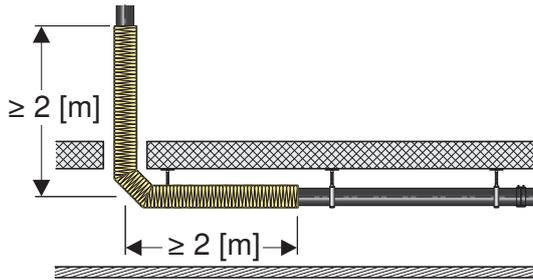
Luftschalldämmung im Bereich eines Falleitungsverzugs oder beim Übergang einer Falleitung in eine Sammelleitung
